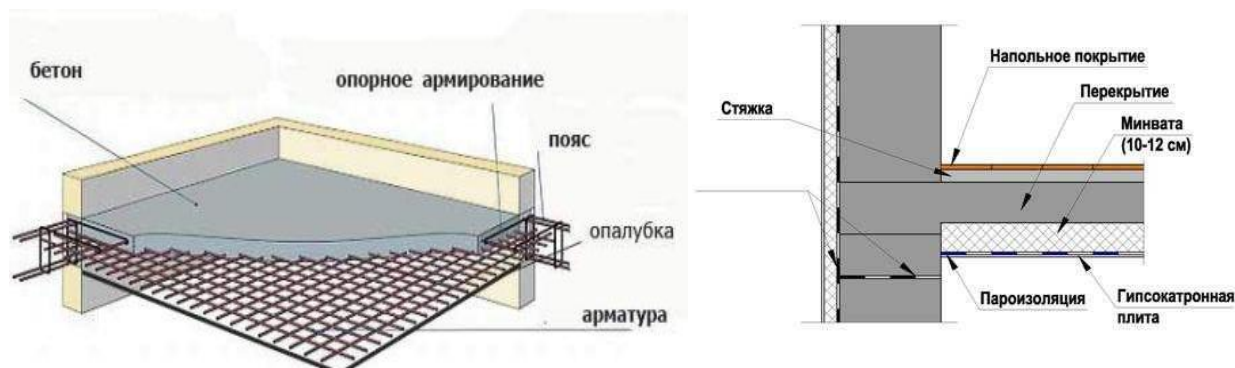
Конструктивное решение междуэтажных перекрытий
